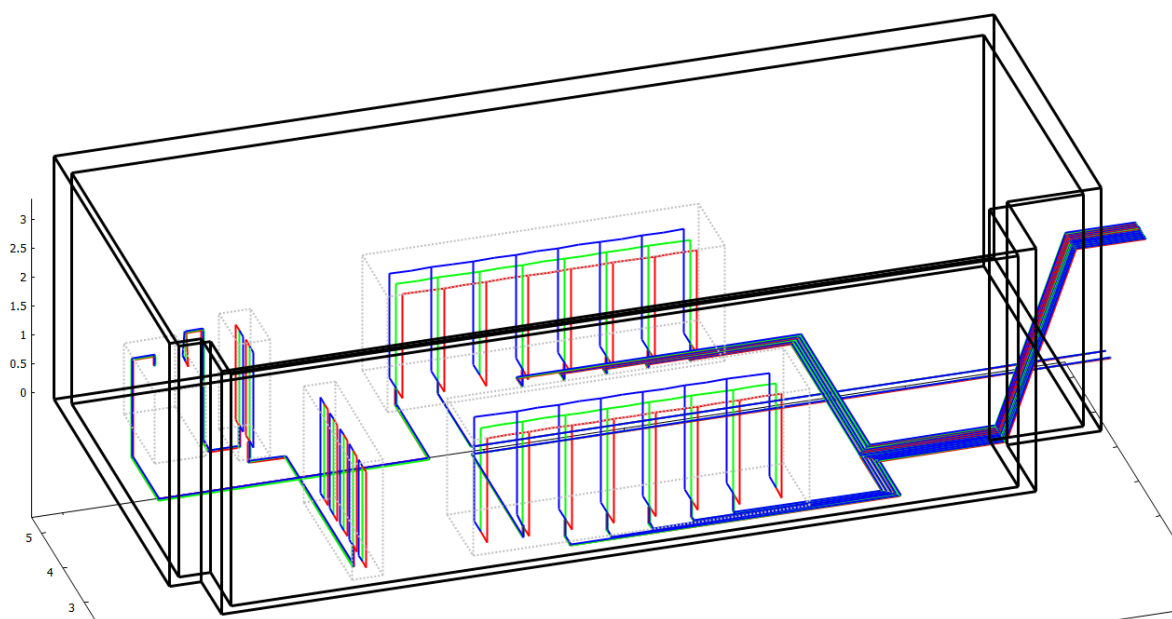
Layout del locale Cabina Elettrica – vista in pianta
